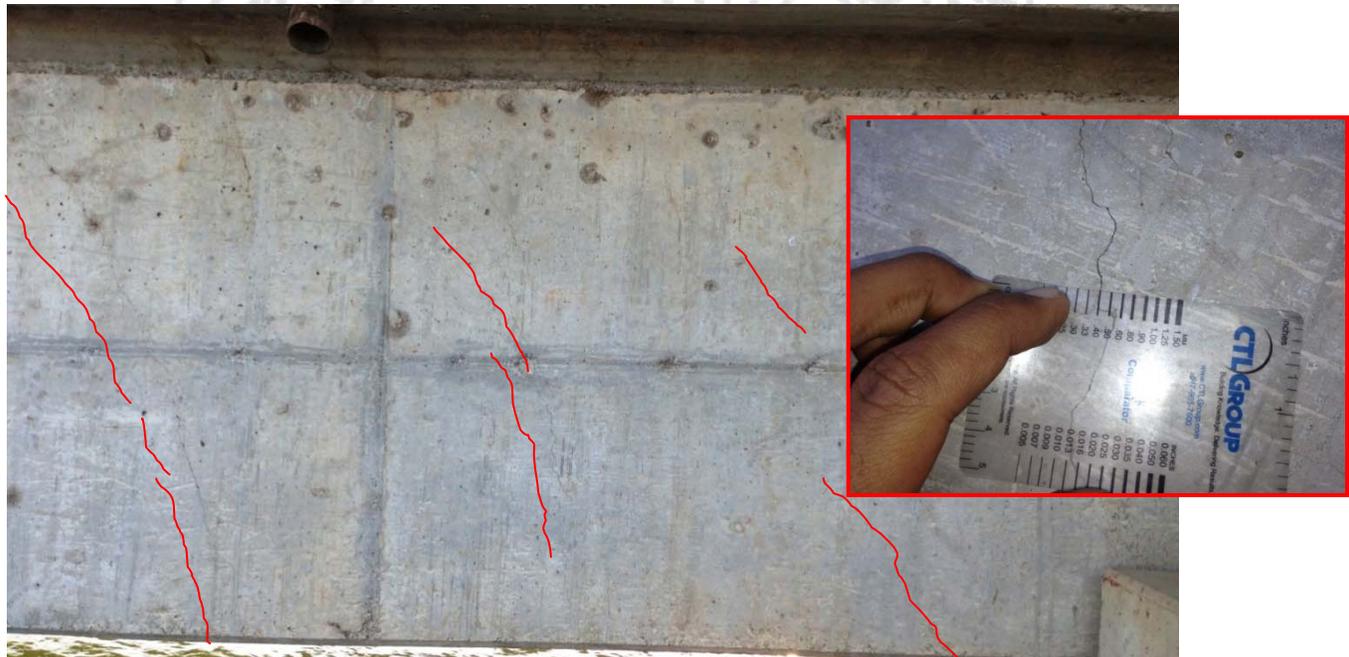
Grietas por cortante en las vigas principales cerca de los apoyos, con un ancho de 0,40 mm.
